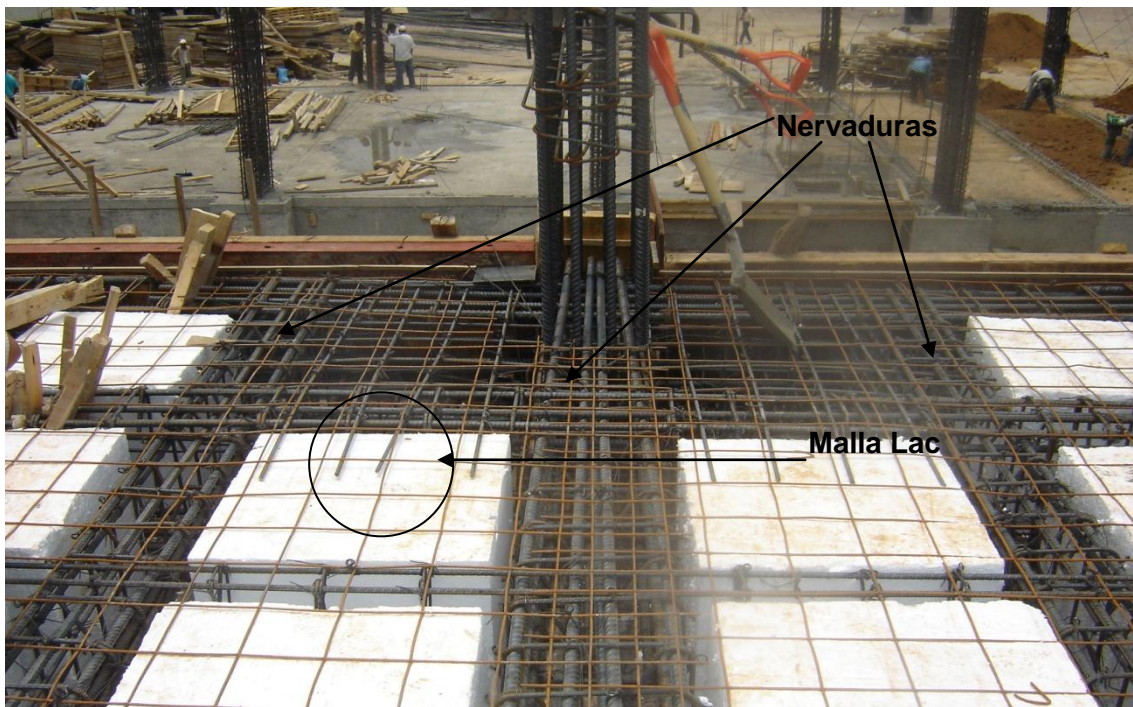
Colocación de malla Lac 6 x 6 – 6/6 y Nervaduras
